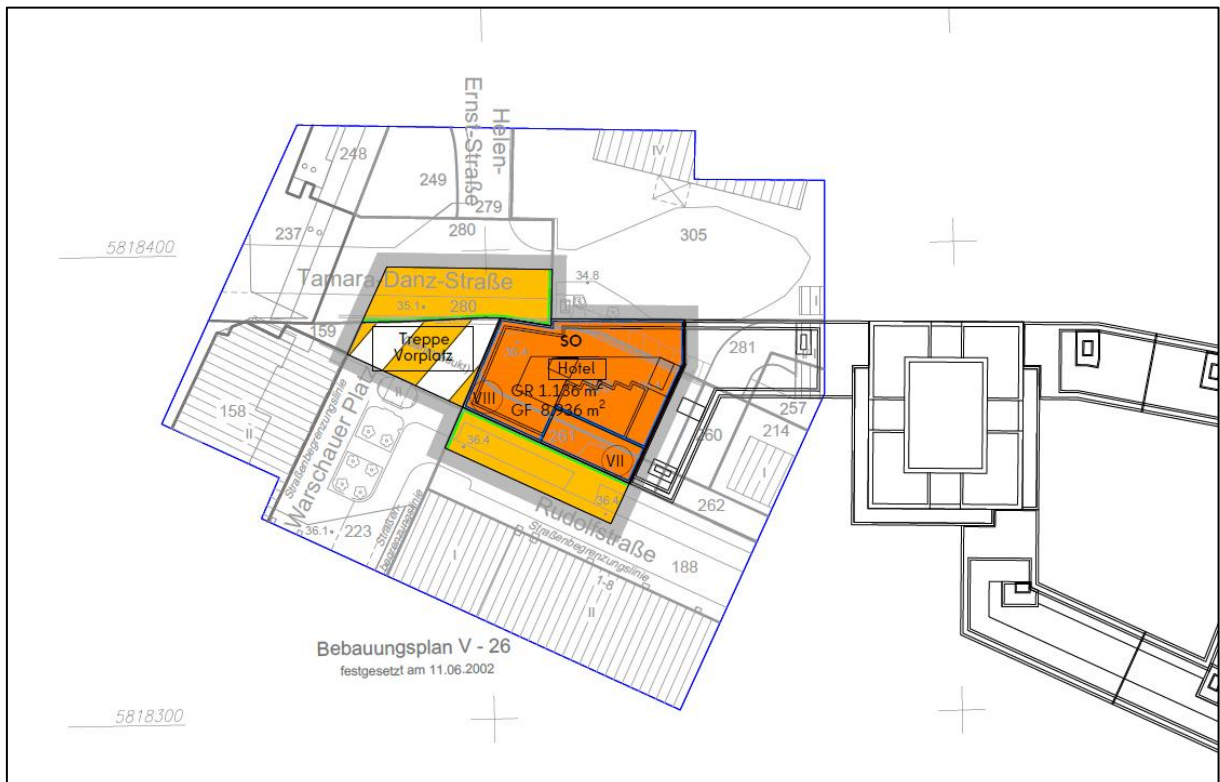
Erschließungsplan zum Bebauungsplan V-67b VE (Arbeitsstand 21.01.2026)
